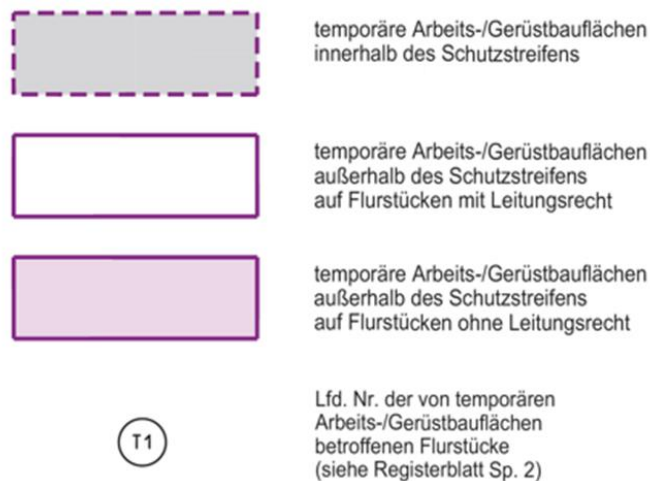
Darstellung Arbeits-/Gerüstbauflächen
